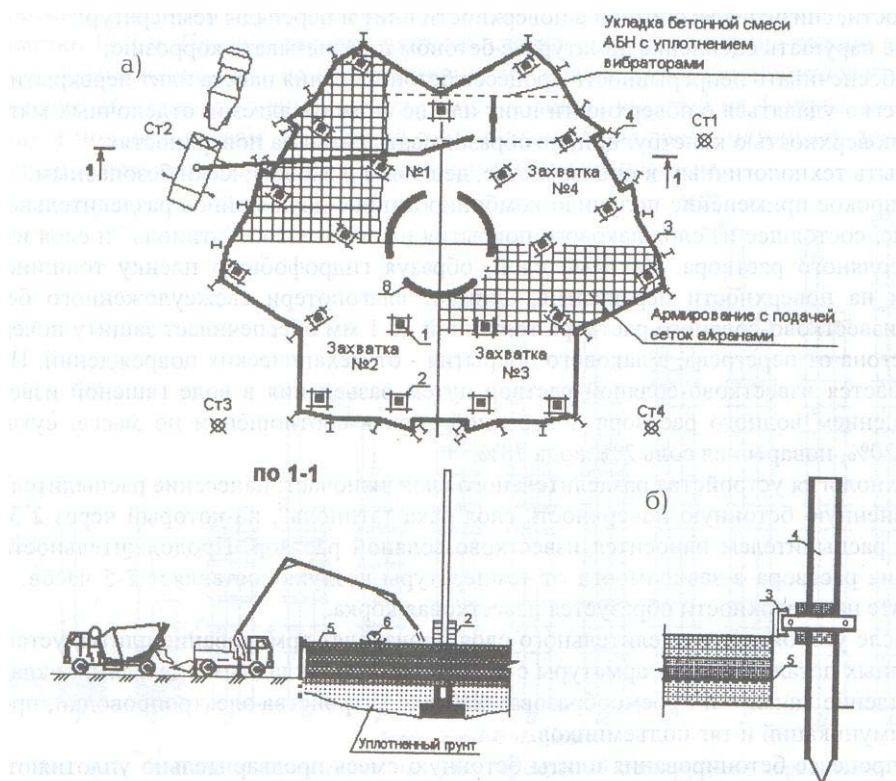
Технология устройства перекрытий: а) устройство опалубки, армирование и бетонирование плит с разбивкой на захватки; б) схема инвентарной опалубки; 1 – колонна; 2 – воротник; 3 – инвентарная опалубка; 4 – стойки по периметру плиты; 5 – монолитная плита; 6 – виброрейка; 7 – автобетононасос; 8 – ядро жесткости
